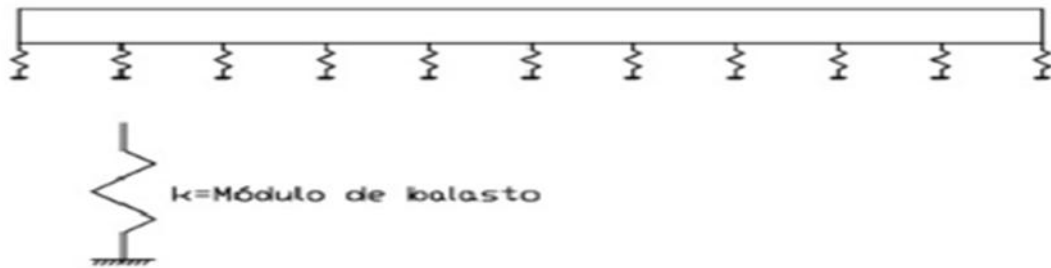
Viga de cimentación con apoyo de resortes elásticos (modulo de balasto).
